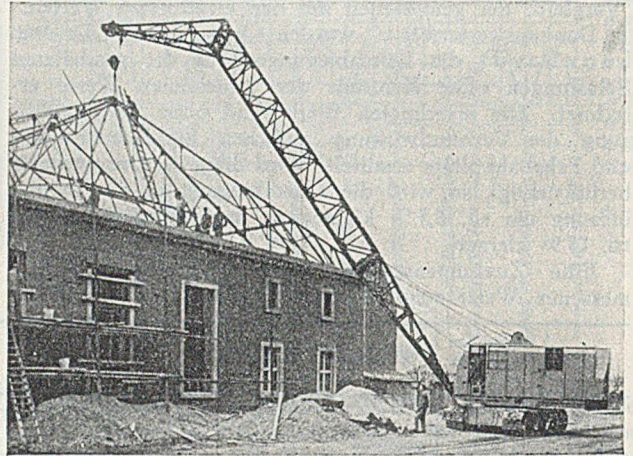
Universalbagger B 315 mit (geknicktem) Schiffbau-Ausleger bei der Montage von Dachbindern, als Kran arbeitend.
